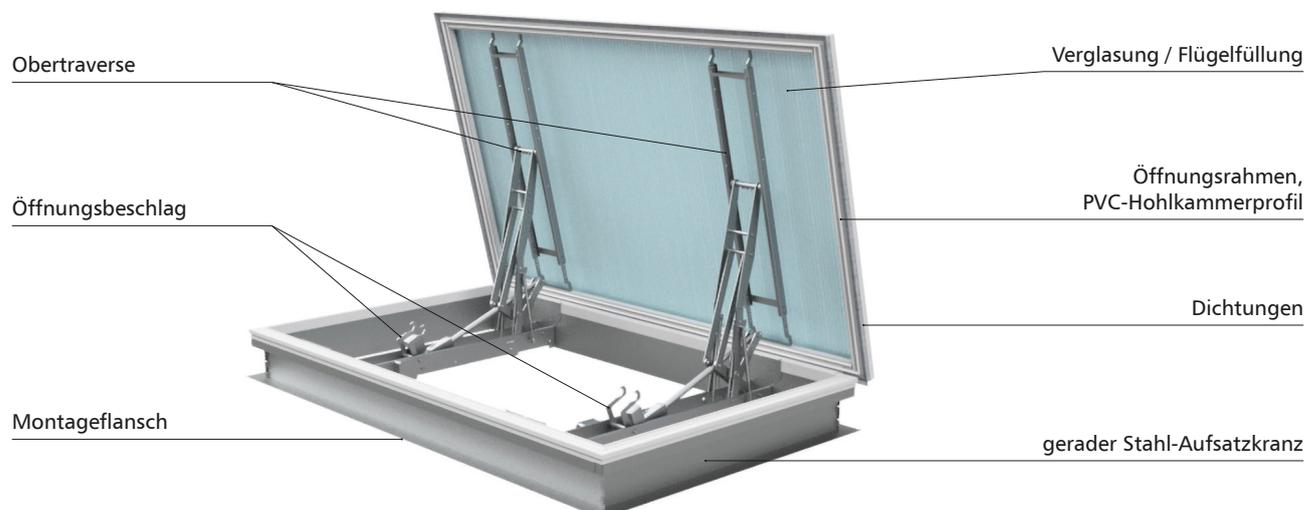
Aufbau eines RWA-Gerätes mcr ULTRA THERM Typ E mit geradem Stahl-Aufsatzkranz in Dachausstiegsausführung mit zwei elektrischen Antrieben
